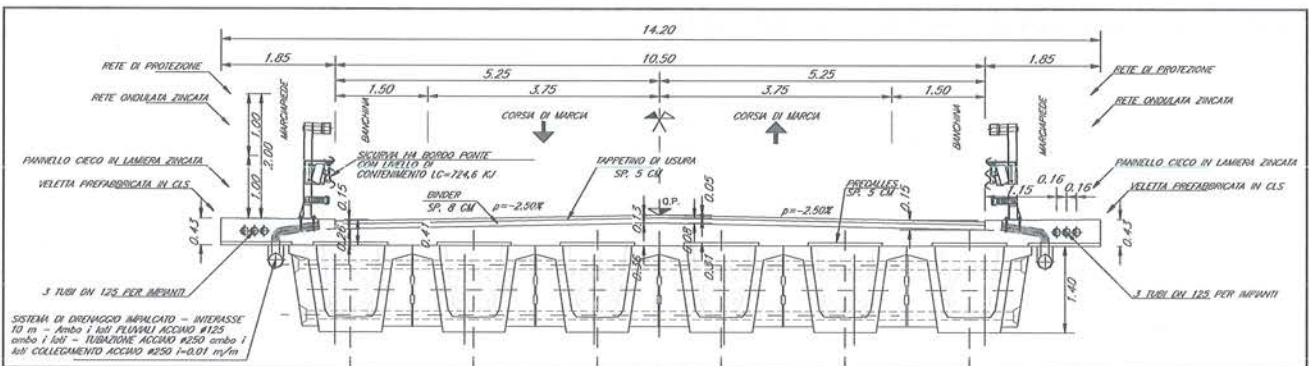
Sezione tipo cavalcaferrovia campata. L=25.00 m
